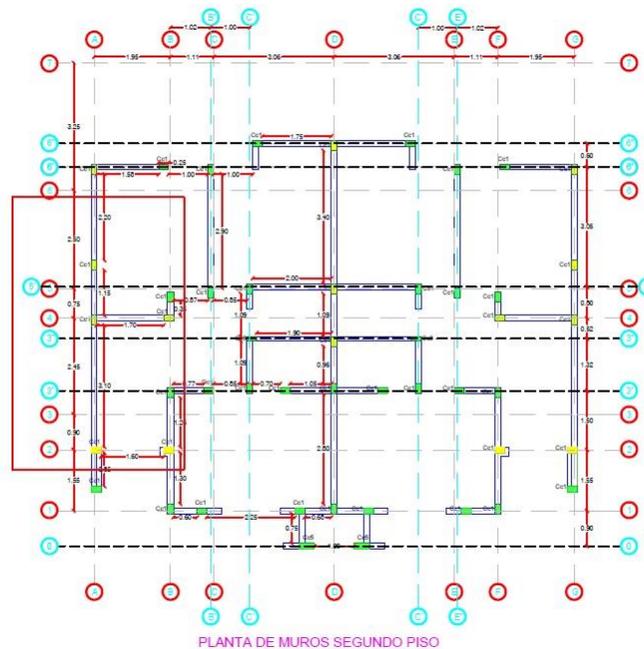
Diseño Estructural, Columnas y Mampostería Segundo Nivel. Fuente Diseño Ing. Carlos Ariel Hurtado.
